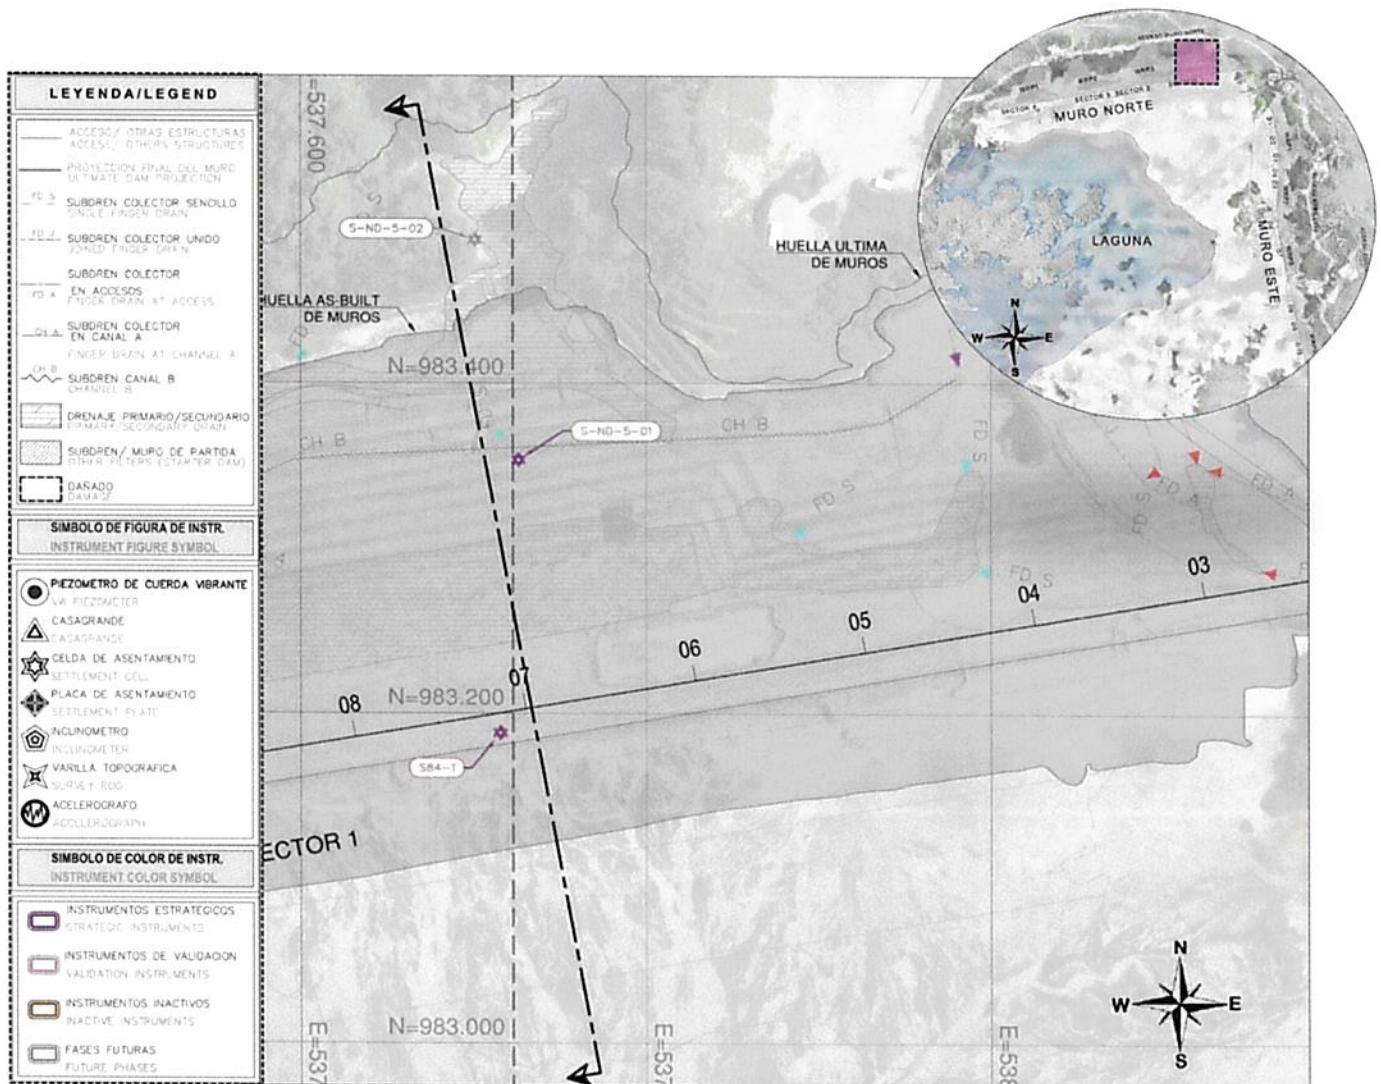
Vista de Planta en el Muro Norte Sector 1 con las Celdas de Asentamiento
